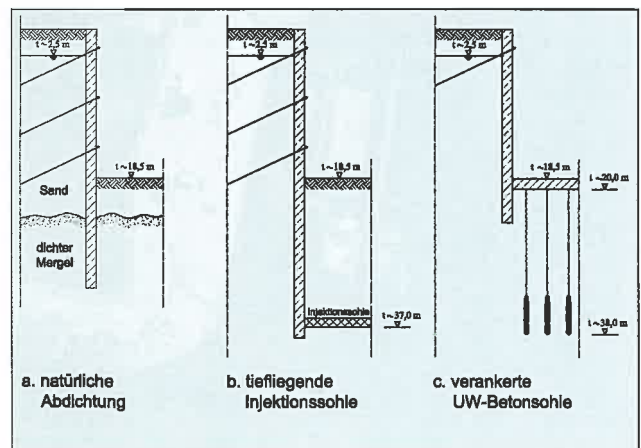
Offene Baugruben im Grundwasser, Bauverfahren
